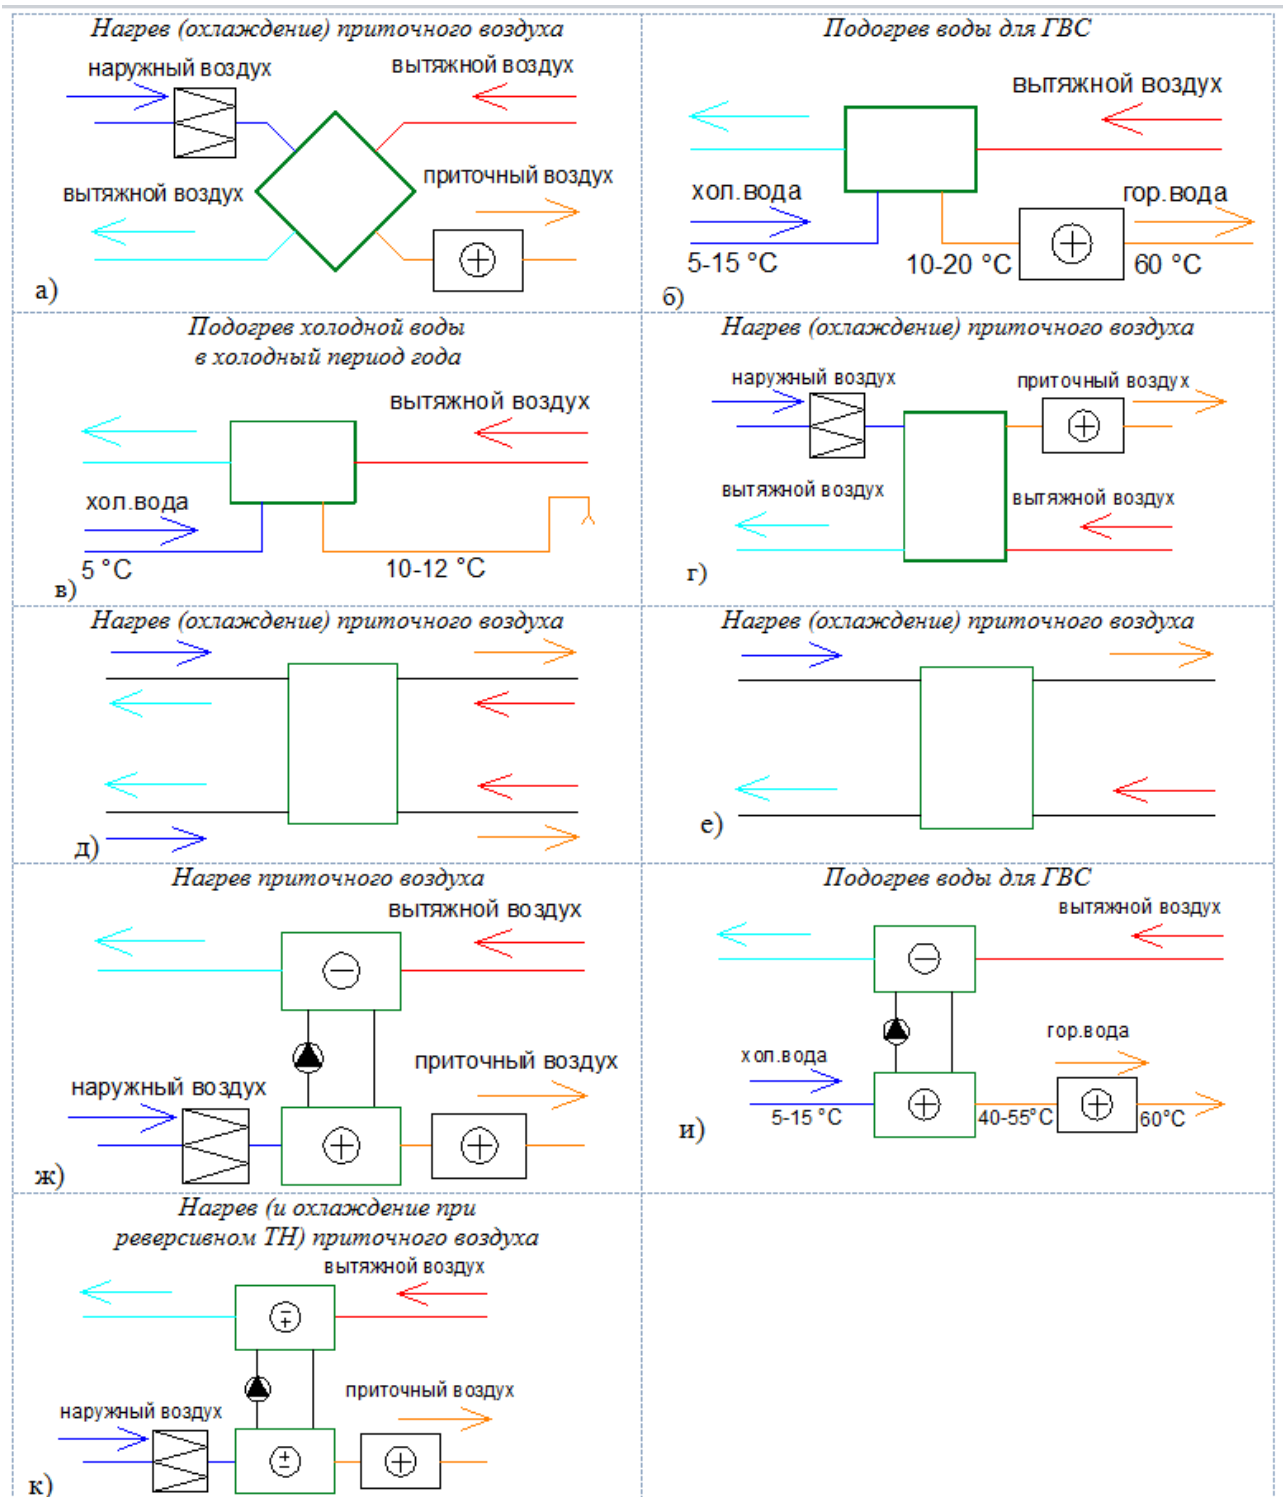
Схемные решения утилизации теплоты удаляемого вентиляционного воздуха с УТ разных типов:
